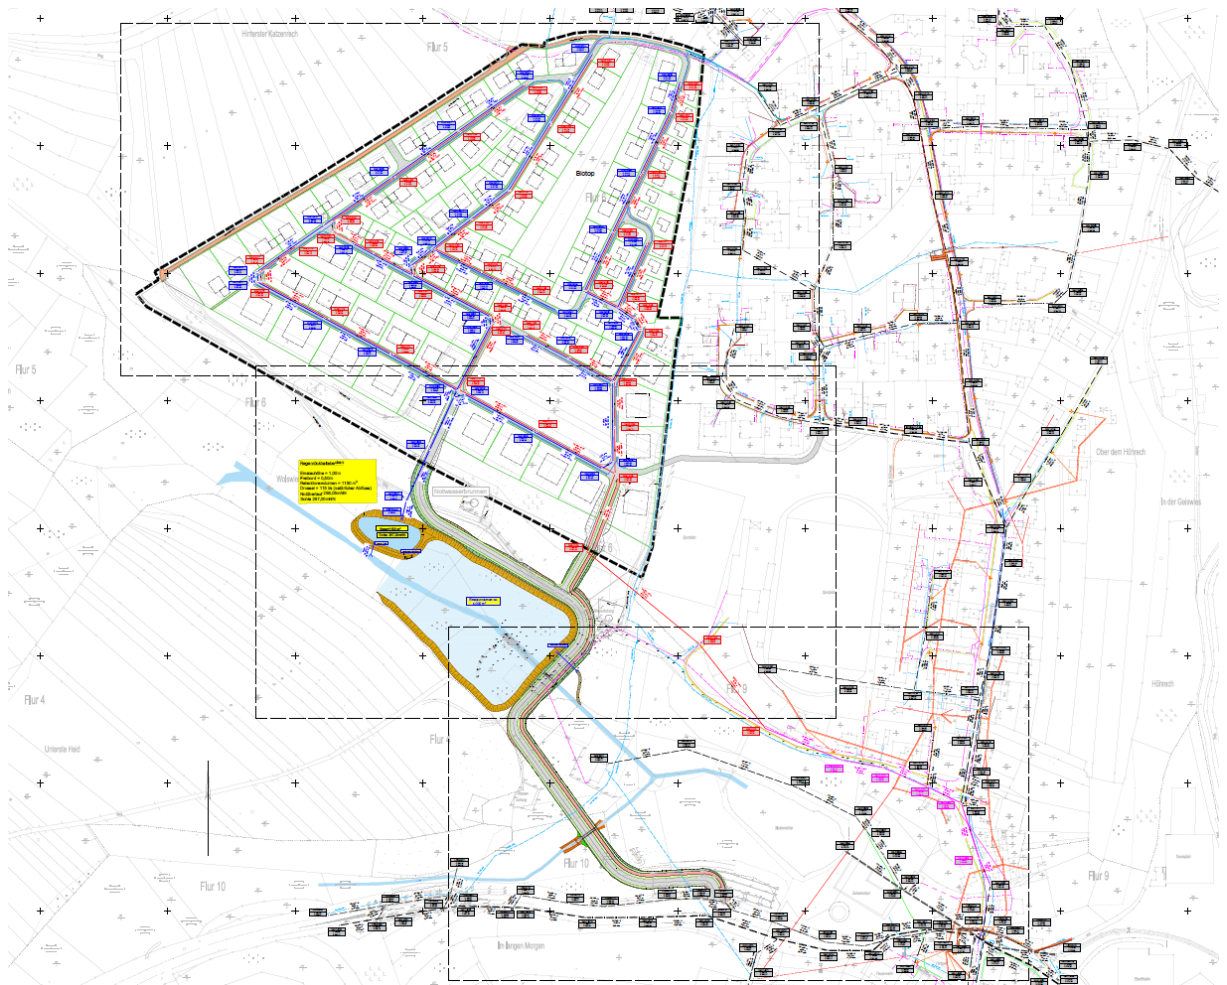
Lageplan Kanal, o.M. (Quelle: P & P GmbH).
